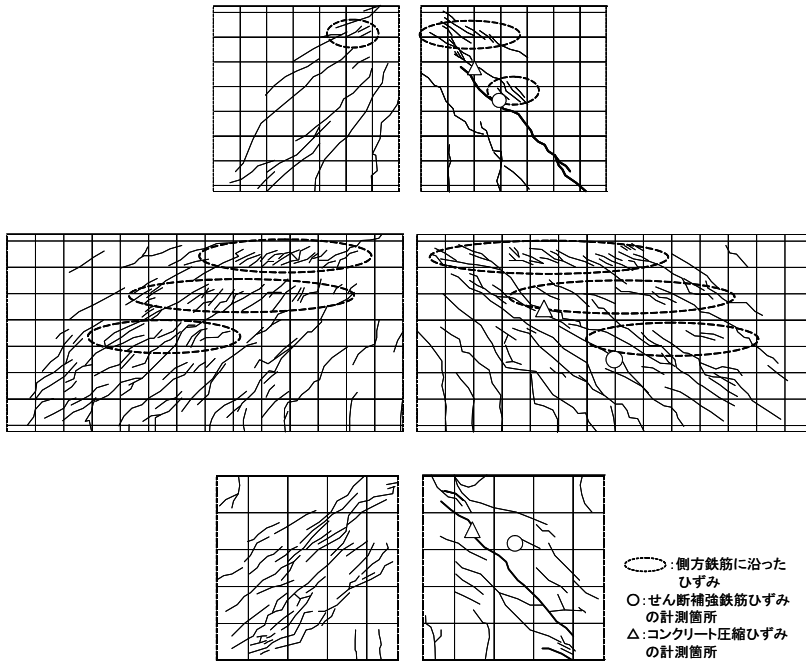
最大荷重時のせん断スパンにおけるひび割れ図
